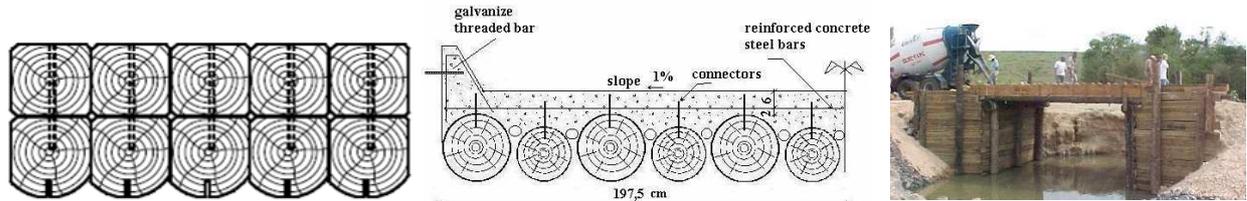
Vigas compuestas de madera maciza (izqda.) (Flach, 2010); tablero de rollizo-hormigón (centro) (Pigozzo et al., 2004) y puente en Brasil (dcha.) (Calil, 2002)
